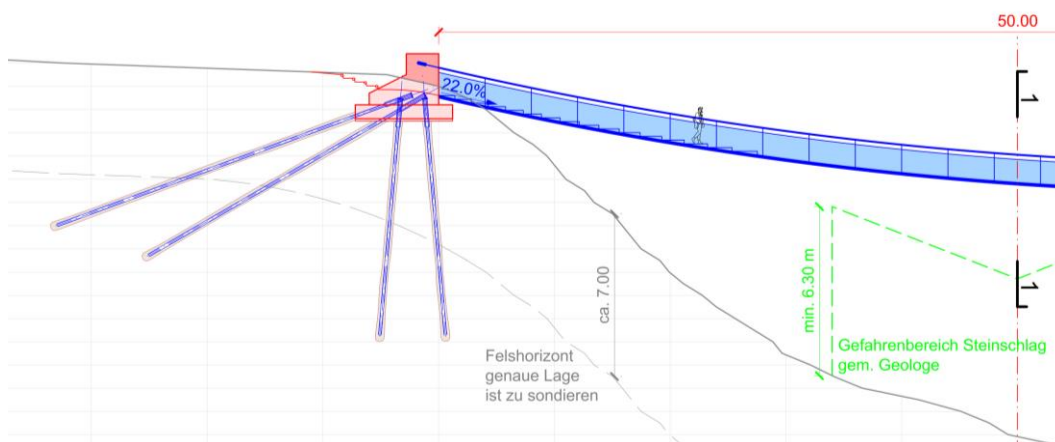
Längsschnitt der Brückenlösung, Teil West (Ausschnitt aus dem Übersichtsplan)
